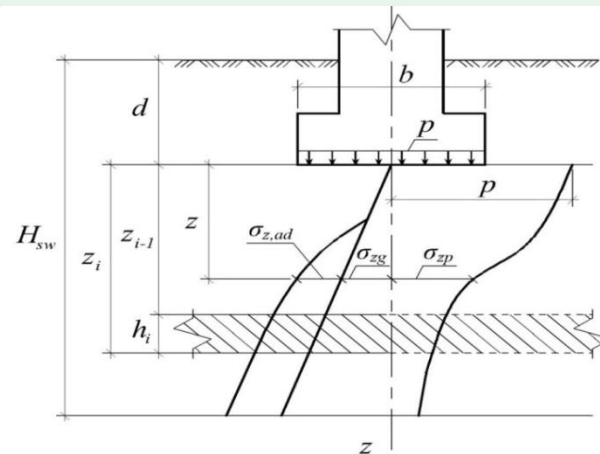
Схема к расчету подъема основания фундамента при набухании грунта
